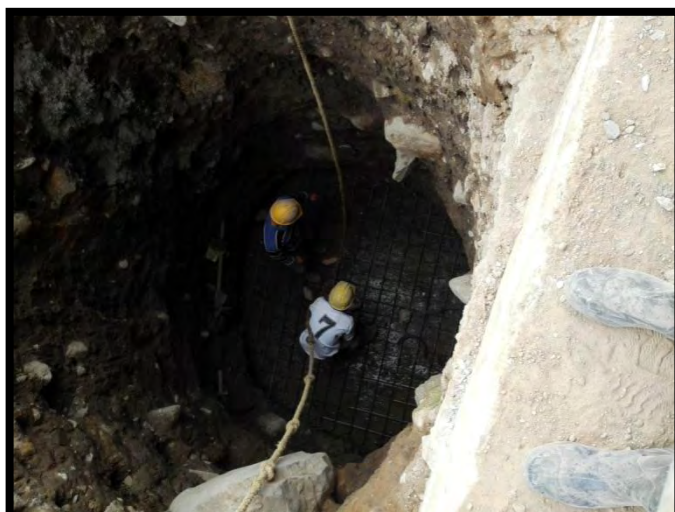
Solado de limpieza y armado de parrilla de refuerzo
